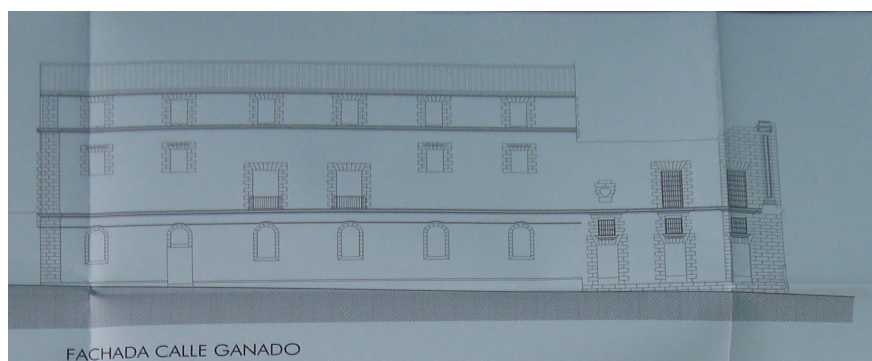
Alzado de la fachada de Hospitalito por calle ganado, (NAVARRO, 2009)
